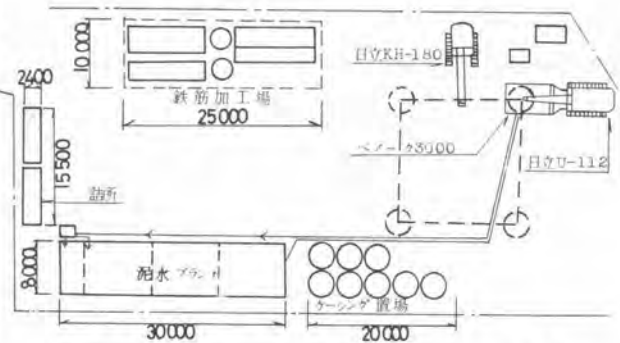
Ⅱ-3-2 基礎施工時の機械・設備の配置
